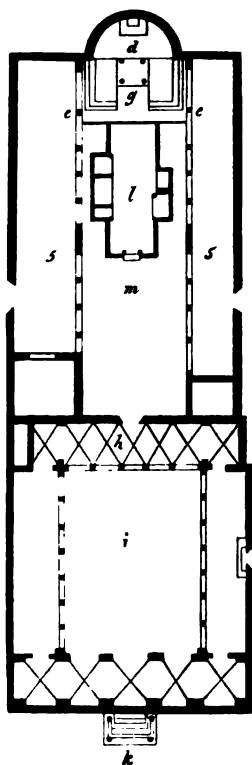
Grundriss von St. Clemente in Rom.
